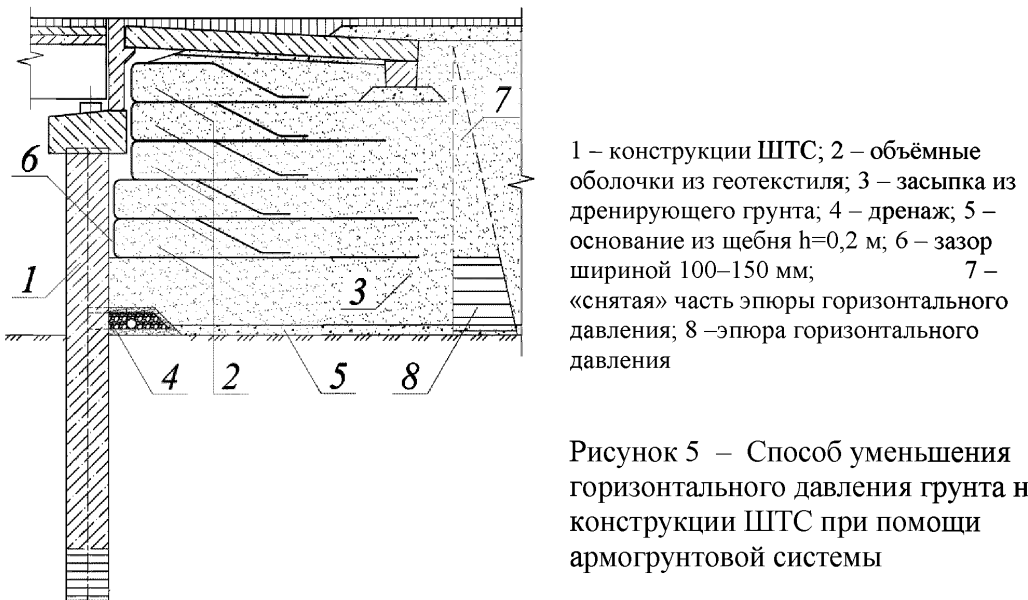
Способ уменьшения горизонтального давления грунта на конструкции ШТС при помощи армогрунтовой системы
